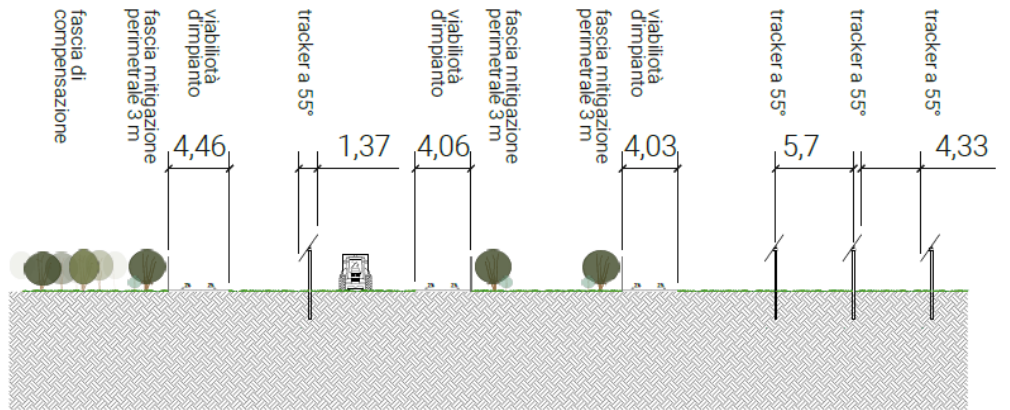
STRALCIO ELABORATO MACOMER4-PDT11 "PLANIMETRIA SISTEMAZIONE A VERDE OPERE DI MITIGAZIONE"
